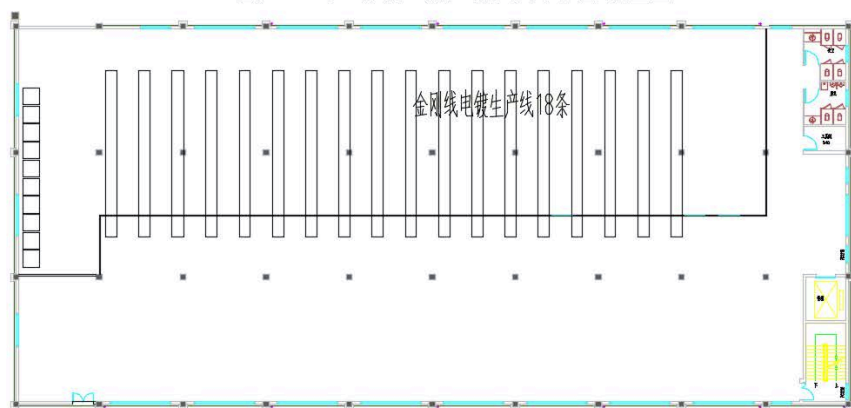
四号楼 2 层/3 层车间平面布置图
